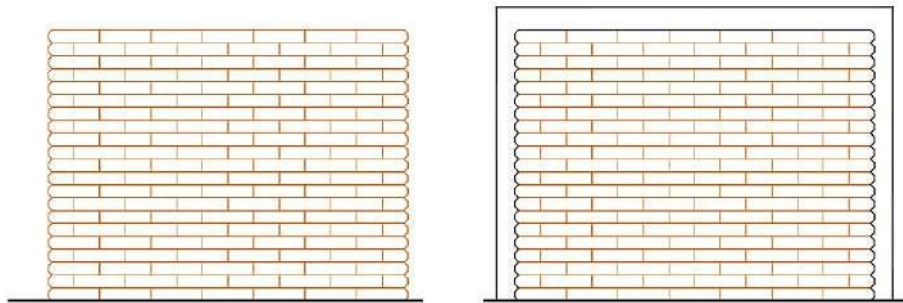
Construcción de un muro de mampostería confinada: construcción de la pared (izquierda) y vaciado de los elementos de confinamiento (derecha). Tomado de Meli *et al.* (2011).
